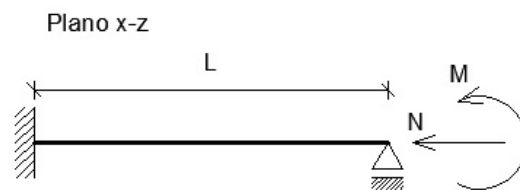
Geometria e carregamento das colunas-viga apoiadas-encastadas
